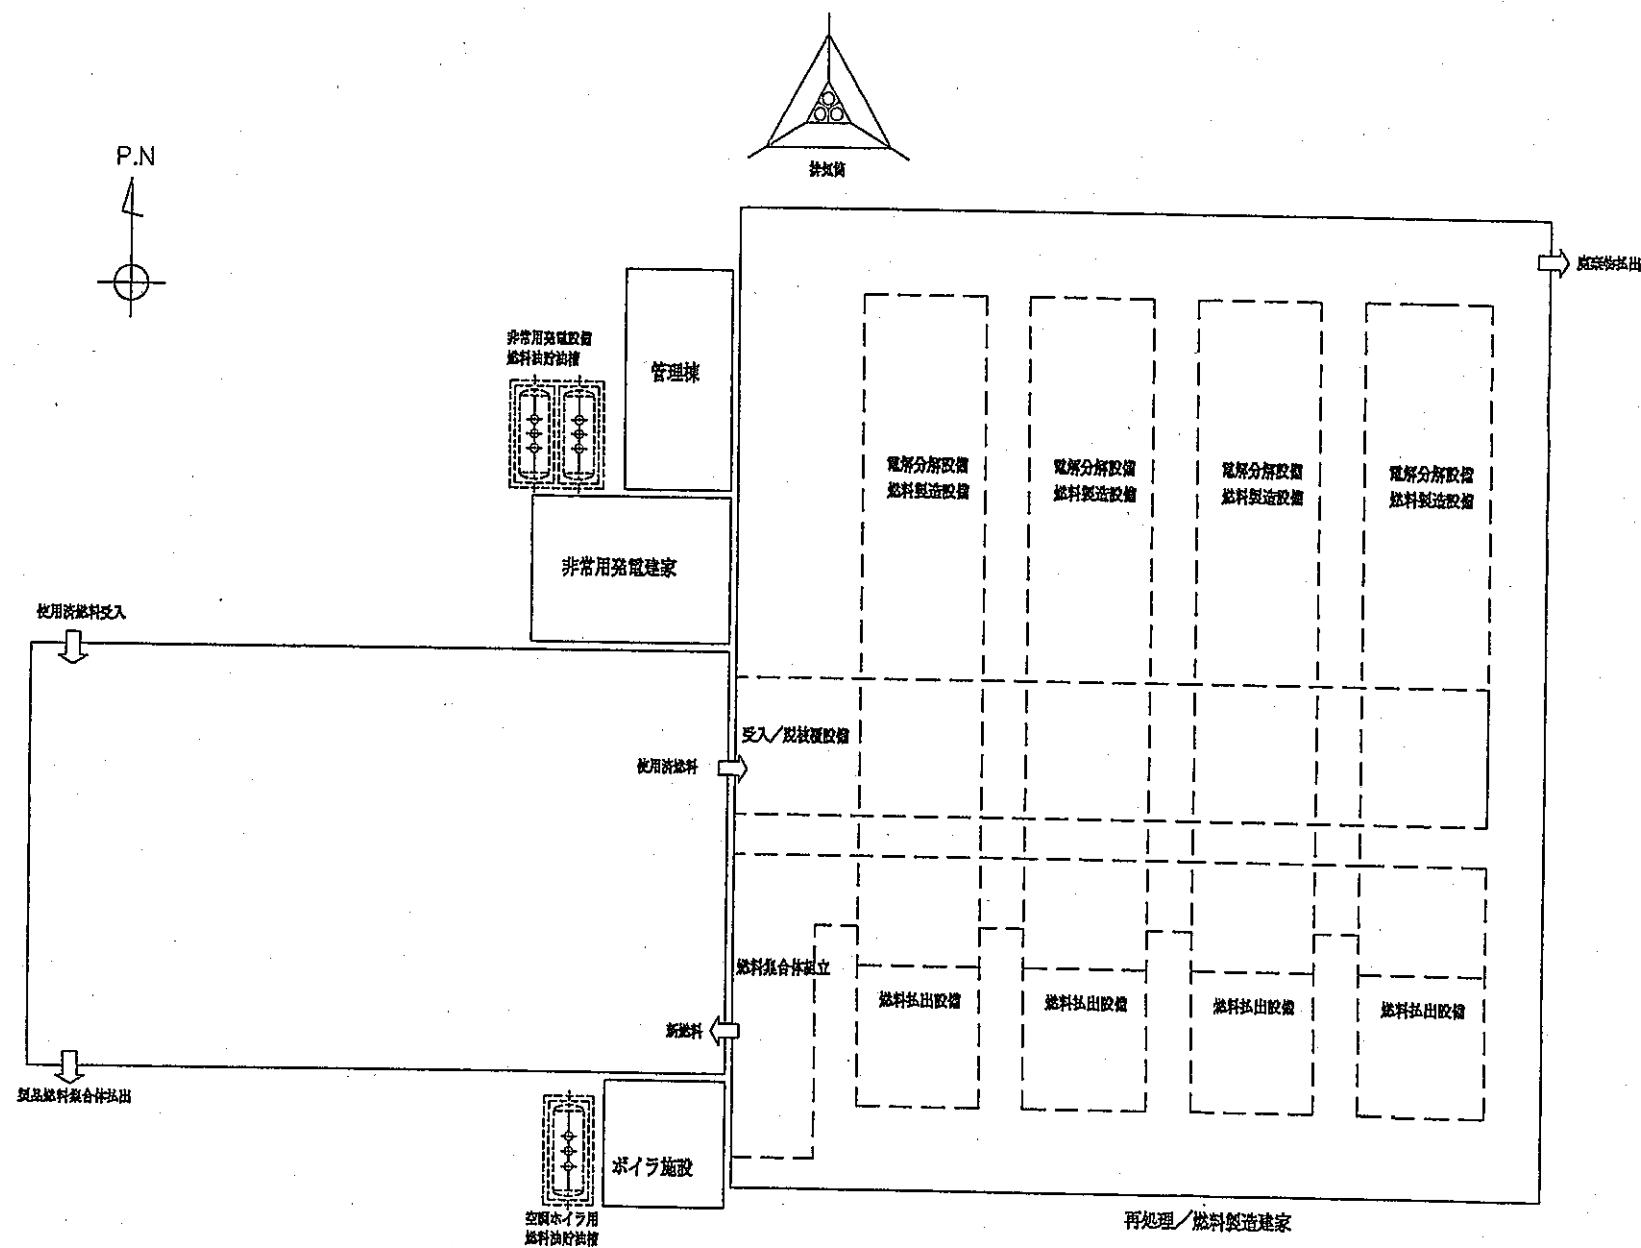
200 t HM/年施設の全体イメージ図（平面図）
